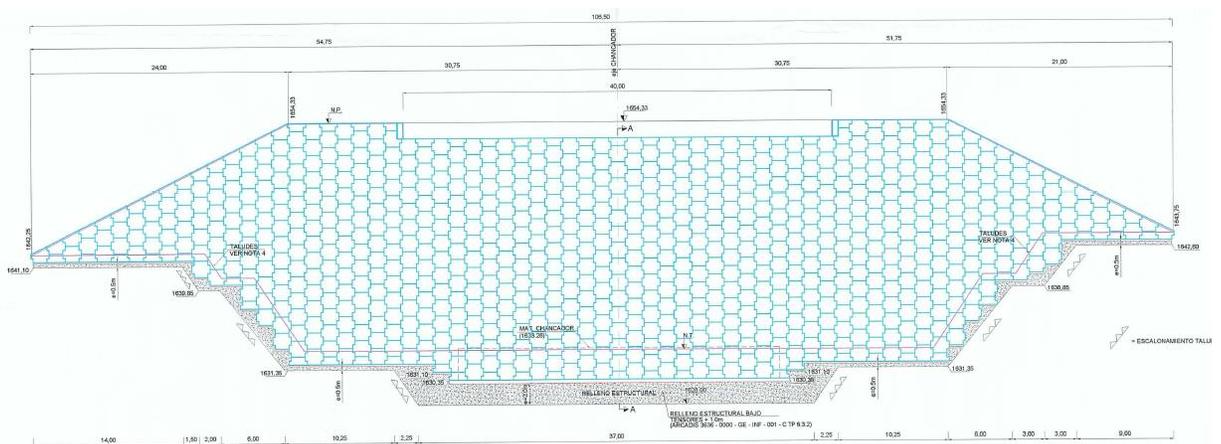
Muro TEM, de la empresa Tierra Reforzada S.A
